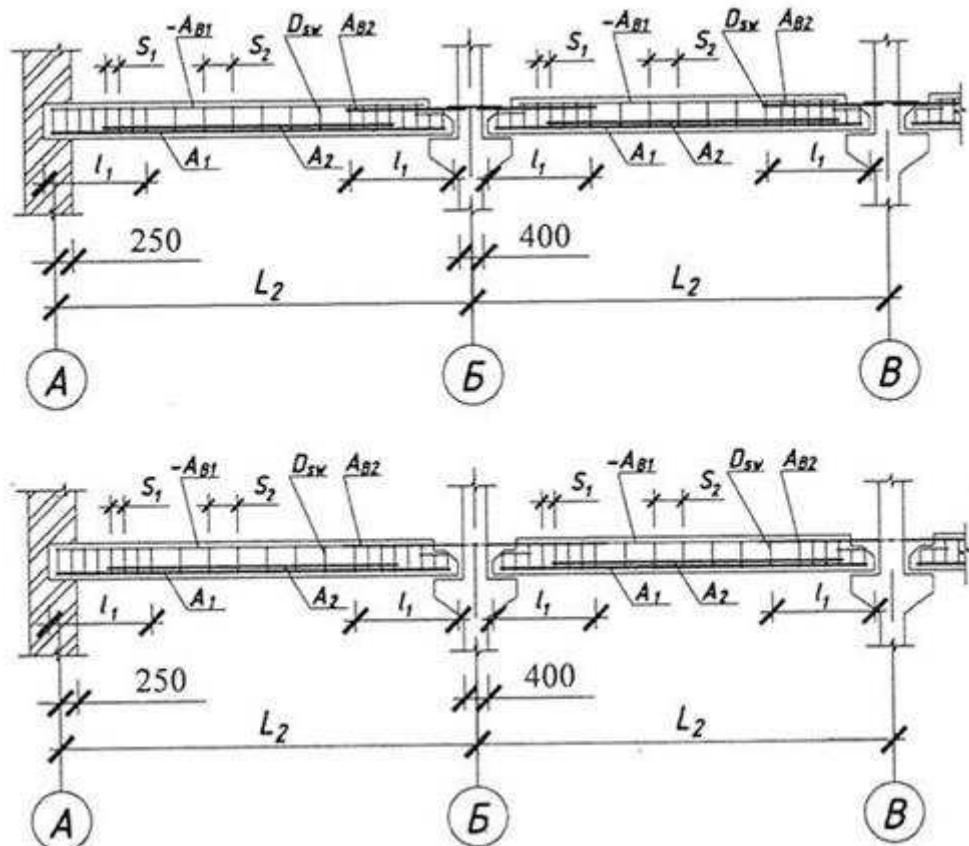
Схемы армирования неразрезного ригеля
